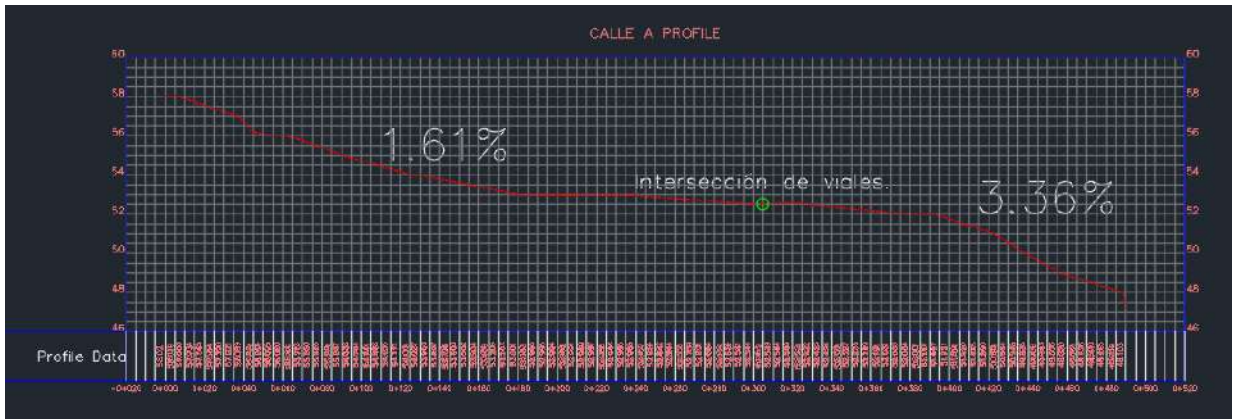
Perfil longitudinal terreno calle principal. Fuente: Autocad.
